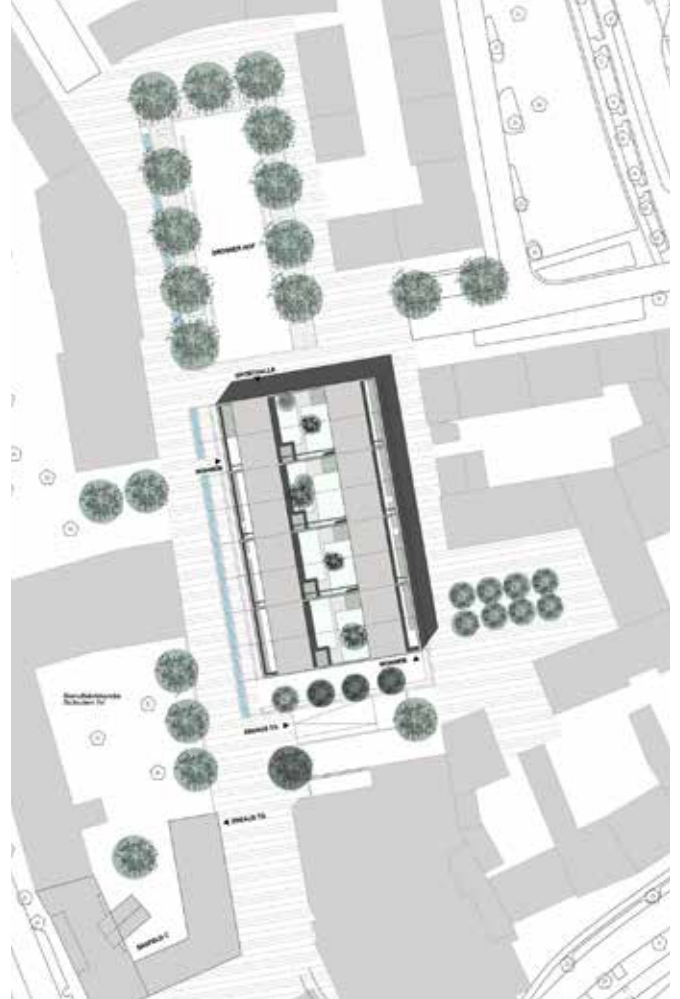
Sporthalle Großer Hof, Reichel + Straut
